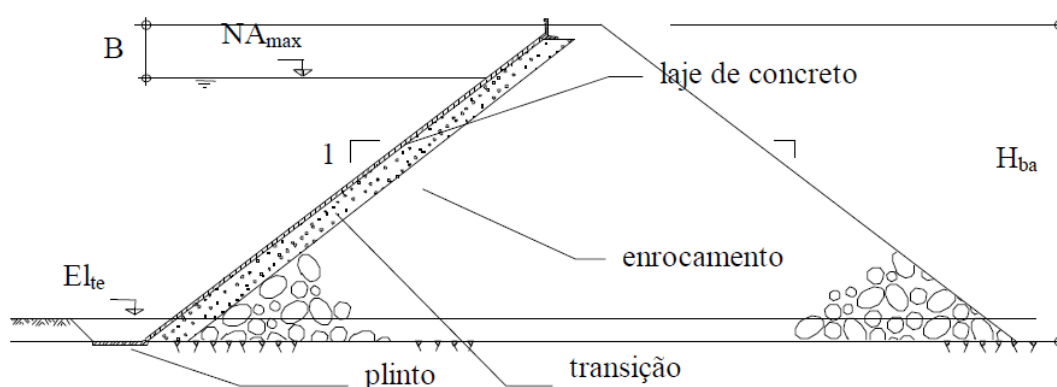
Seção tipo barragem de enrocamento com face de concreto.
